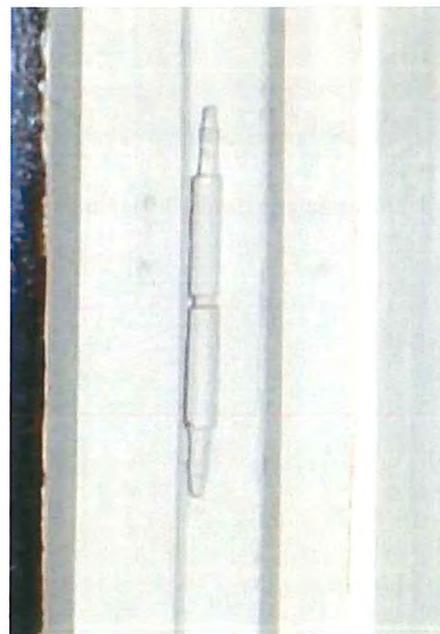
Kellergeschoss, Raum -1.02. Fenster Typ C. Abb. 60: Detail Kellerfenster, Raum -1.02.
